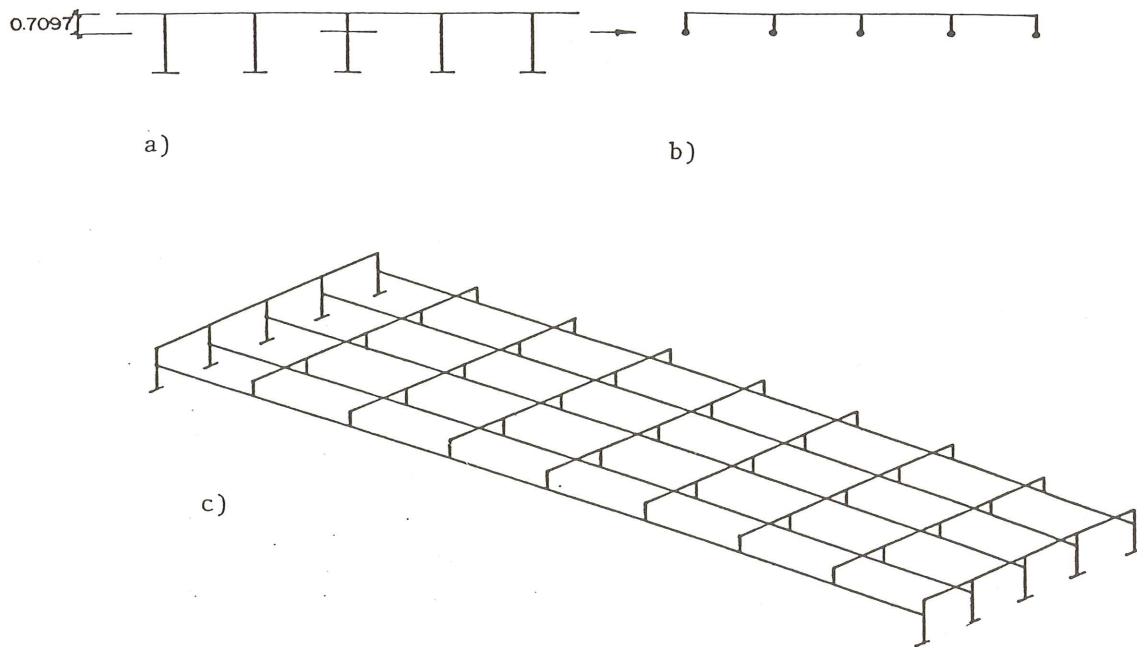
Paso de estructura real a emparrillado espacial. a) Sección transversal real; b) Sección emparrillado; c) Emparrillado espacial.
